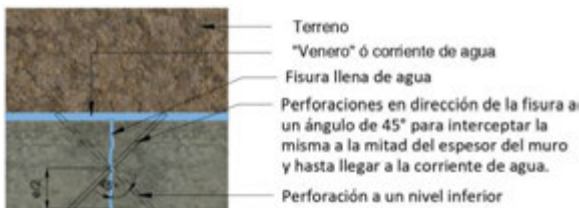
Vista en corte Superior – Perforaciones a 45° atravesando la fisura y llegando hasta el "venero" o corriente de agua
